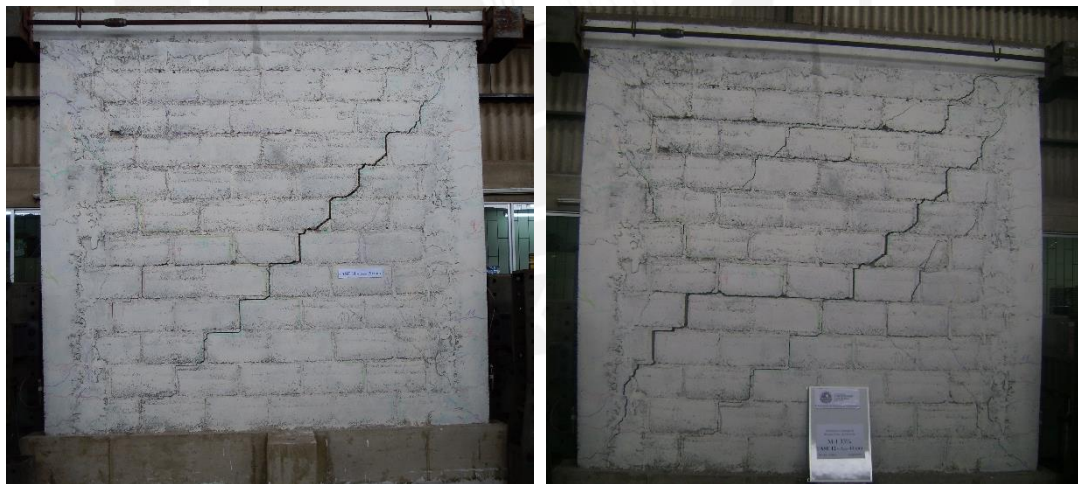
Grieta diagonal marcada sobre el muro.
